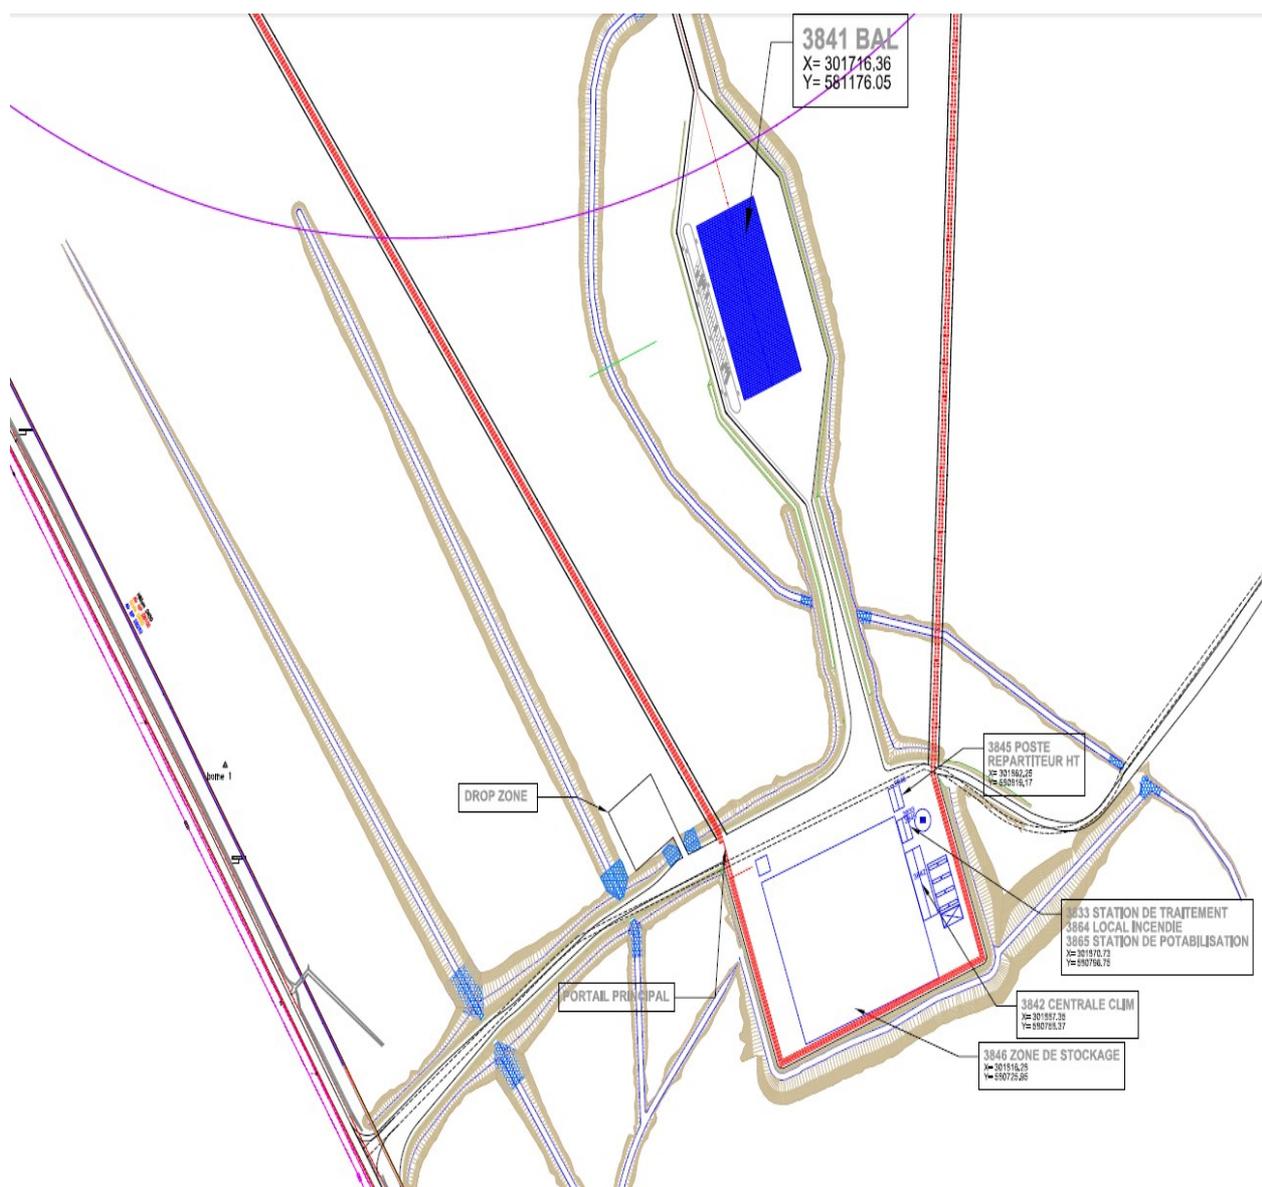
Plan de masse ELA4 – Zoom sur l'entrée - Plan 000-GD-1739-0444-B
